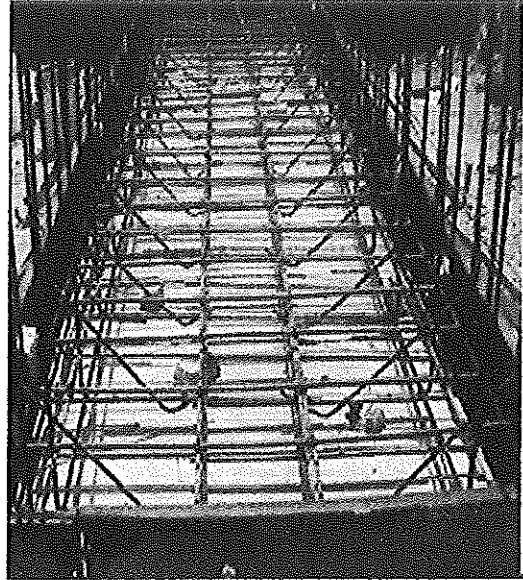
ELABORACIÓN DE OBRAS DE ARTE
